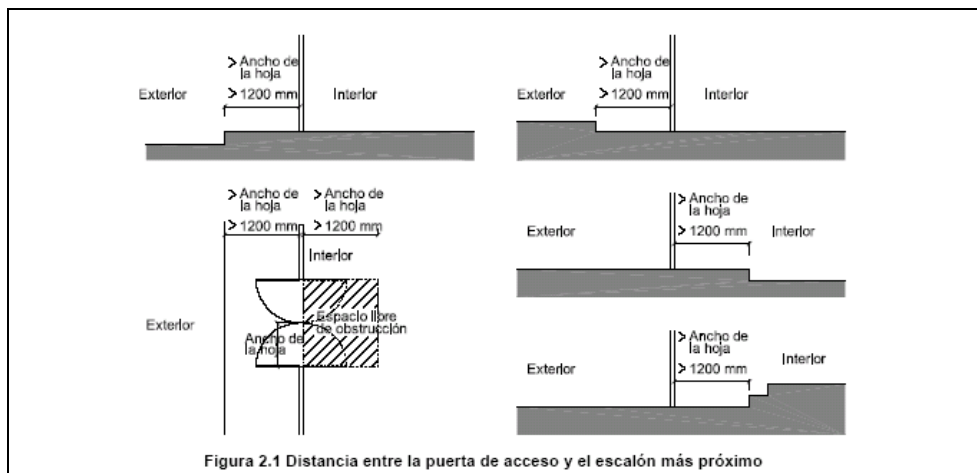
Distancia entre la puerta de acceso y el escalón más próximo
